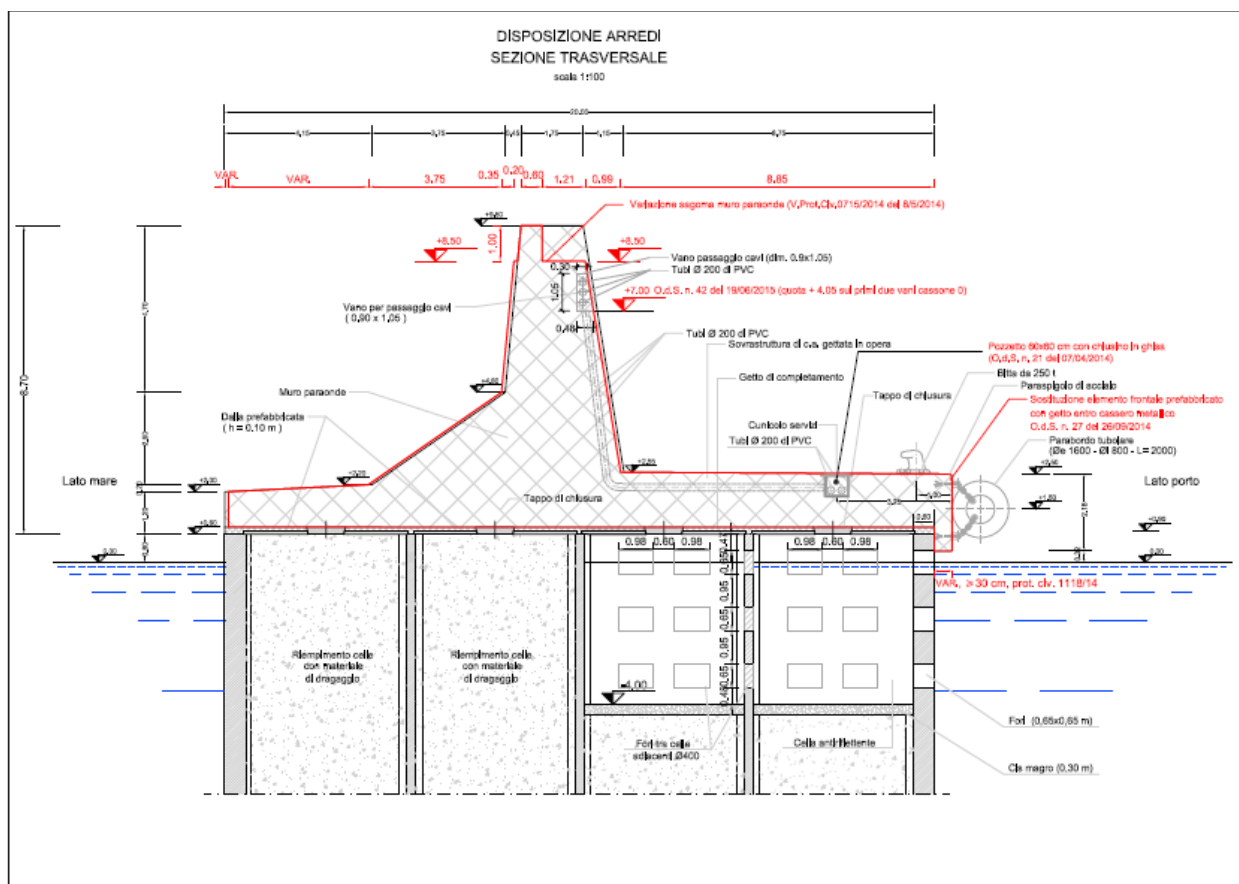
Particolare sezione tipo con indicazione delle modifiche della perizia di variante e suppletiva
